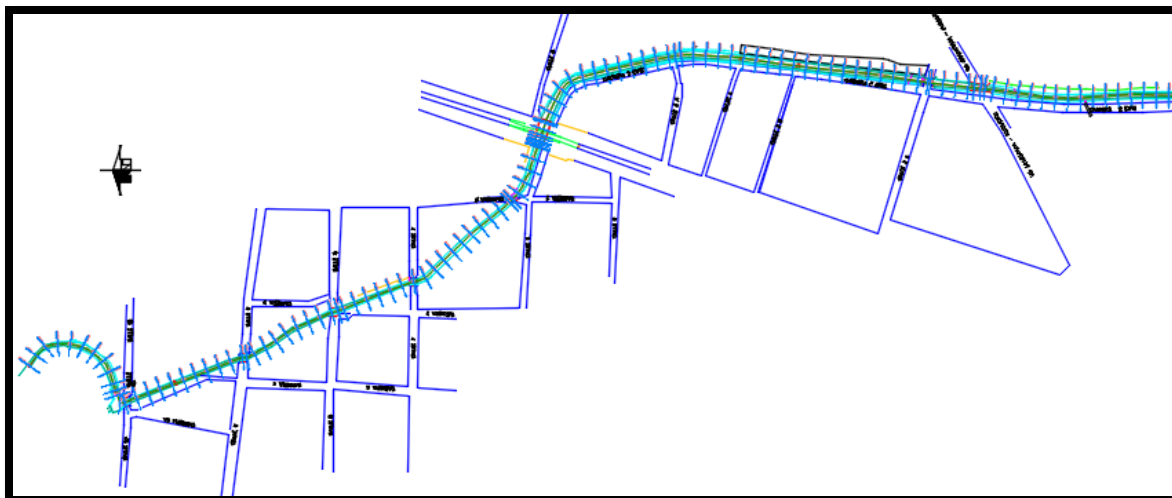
<sup>25</sup> Plano en planta del canal de riego Tolima.
